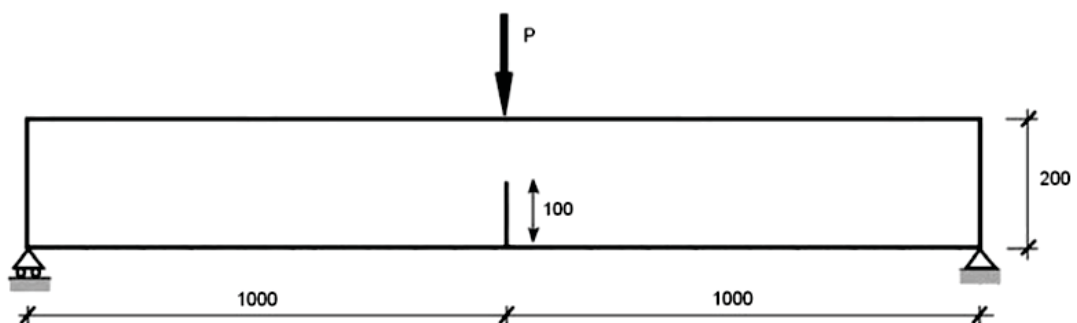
Geometria (em mm) e condições de contorno da viga de concreto entalhada testada por Petersson (1981).
